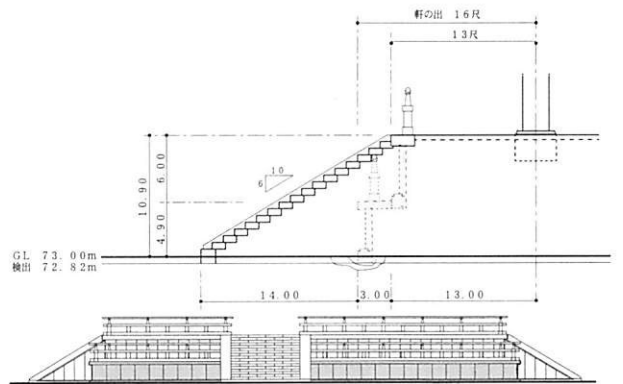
案② 階段部分断面図(1:200)・東立面図(1:500)
